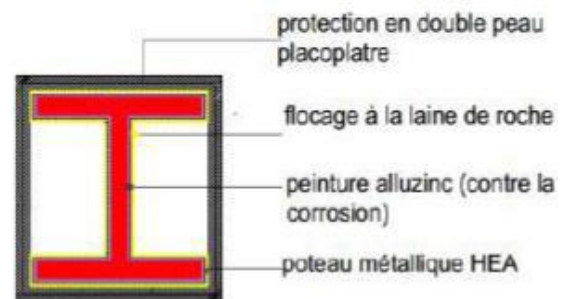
Poteau métallique. Source : www.archdétail.fr
